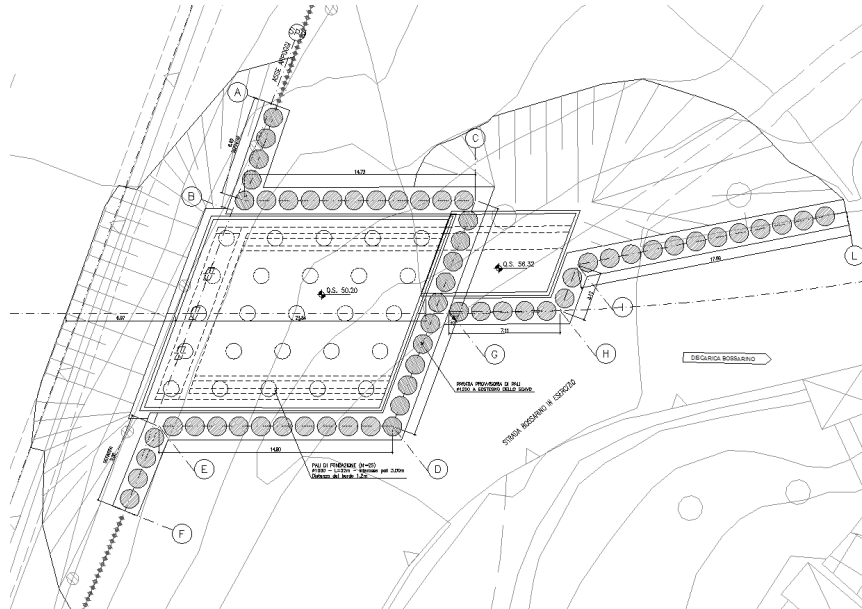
Pianta scavi spallai SPB.
